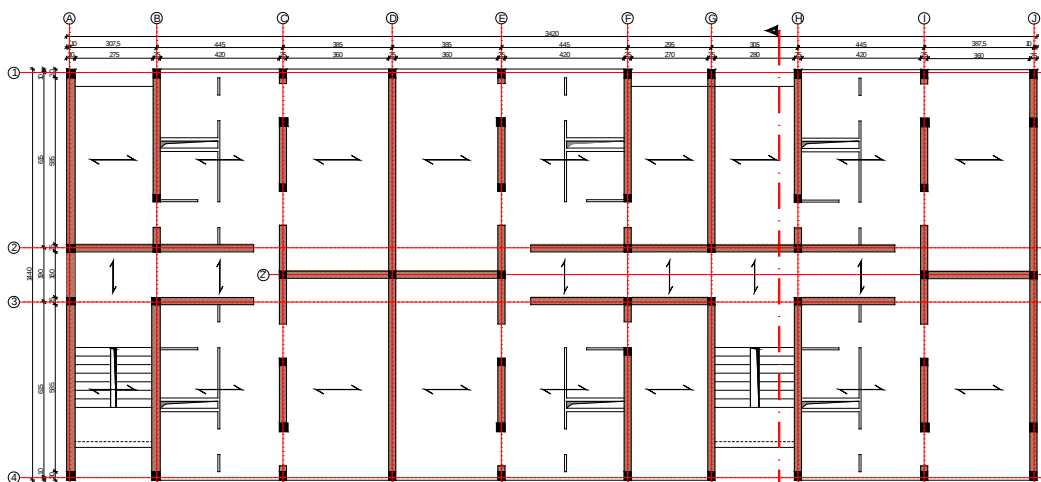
Planimetria e katit të ndërtesës U3/A1, M4H – Muraturë me kufizime BA
